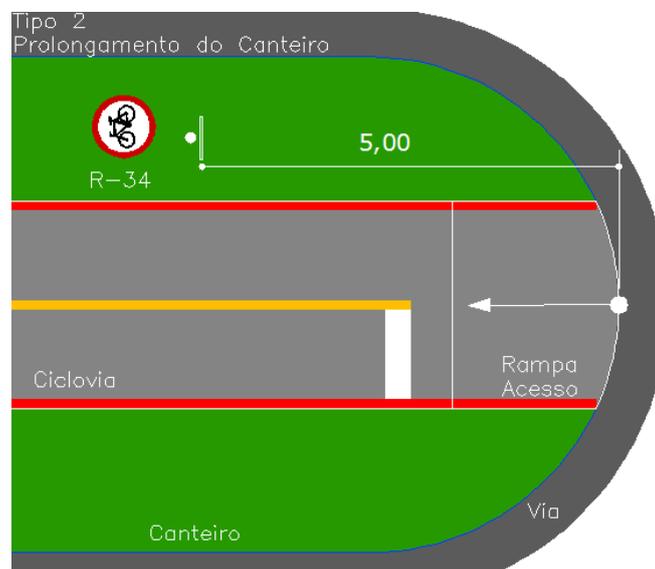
Placa de Regulamentação R-34 – Tipo 2 – Travessia Longitudinal.
